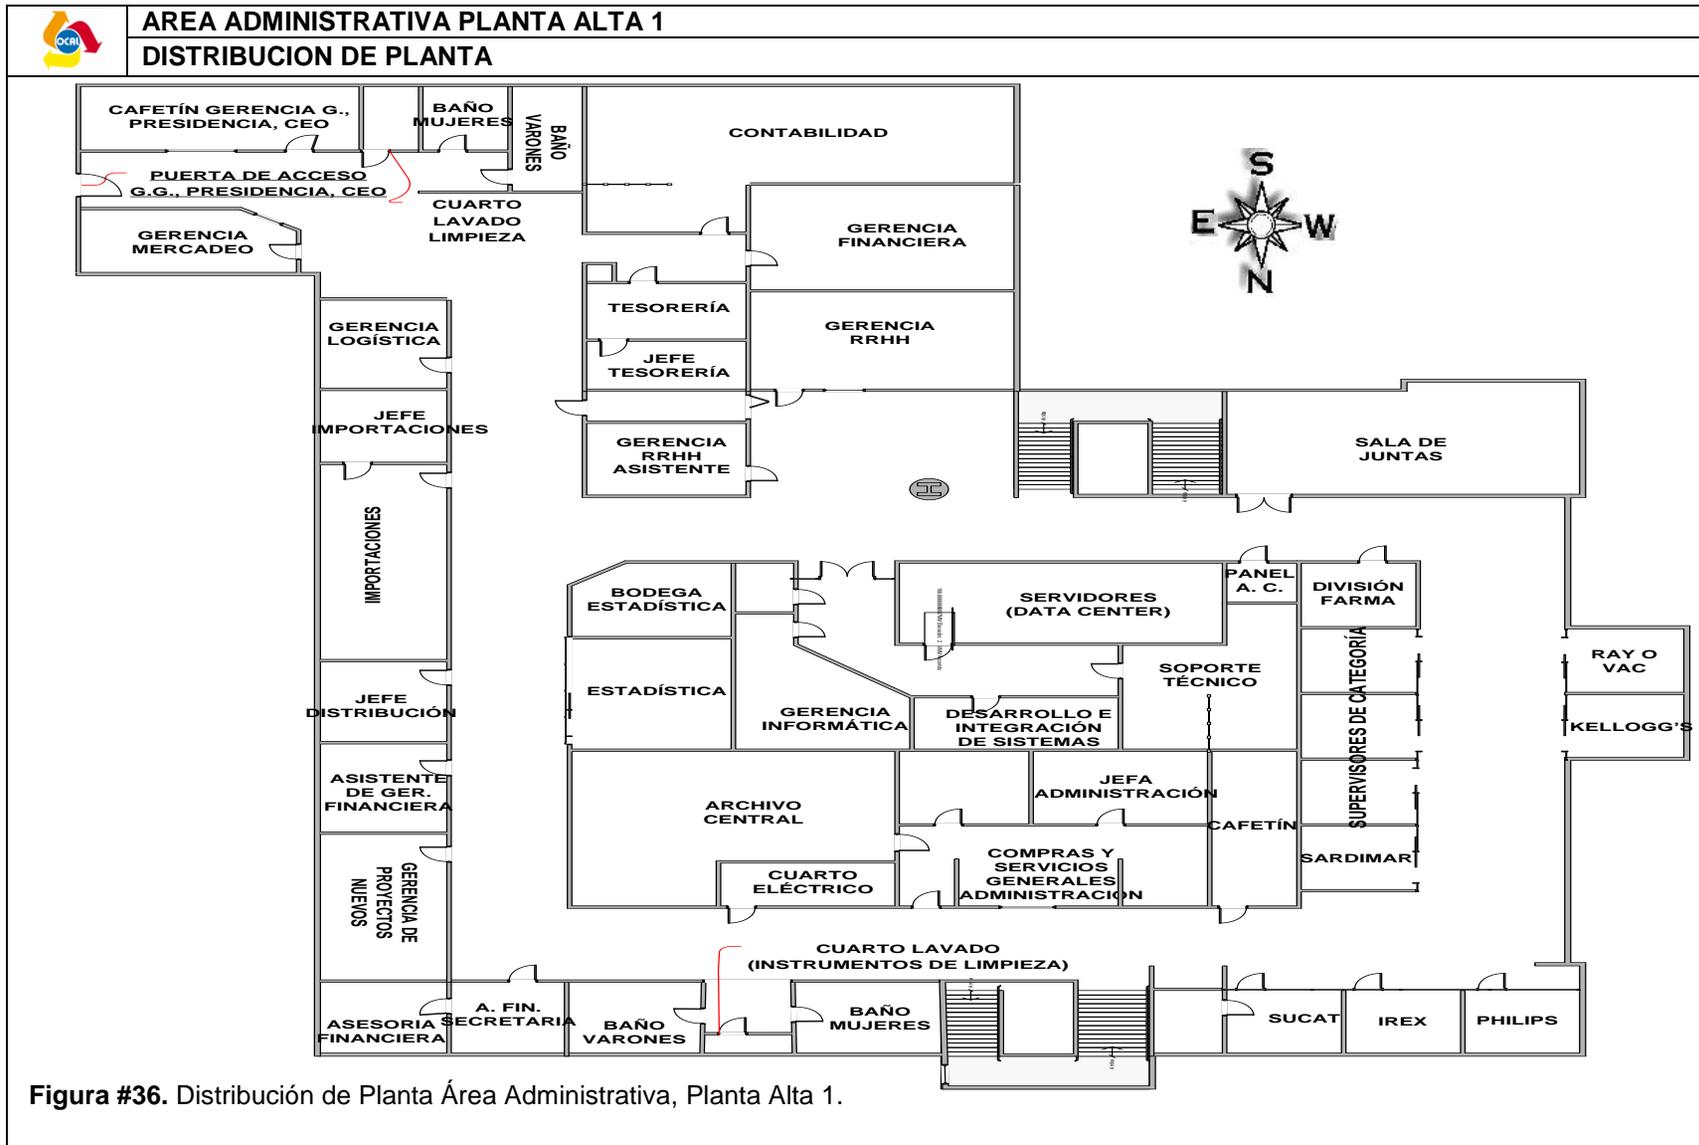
Distribución de Planta Área Administrativa, Planta Alta 1.
